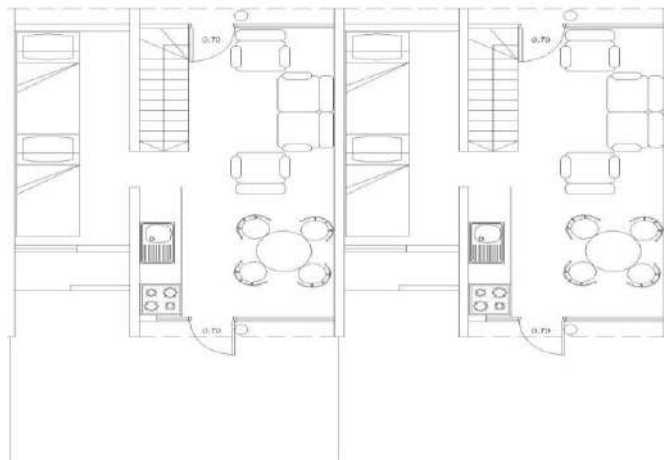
Planta Arquitectónica. Fuente: Elaboración Propia.
